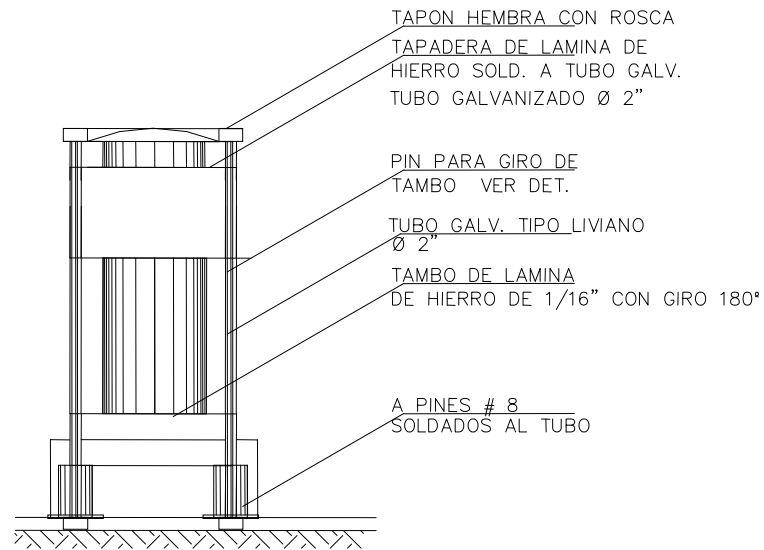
Detalle de Basurero e Áreas Exteriores
